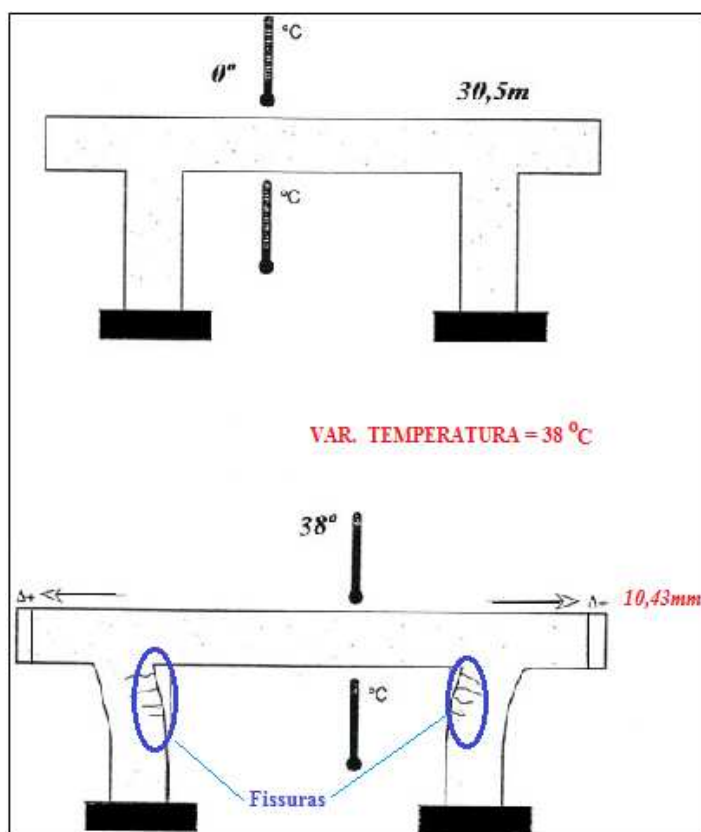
Fissuração por restrição à dilatação térmica do concreto endurecido. Fonte: adaptado de Emmons (1993).
